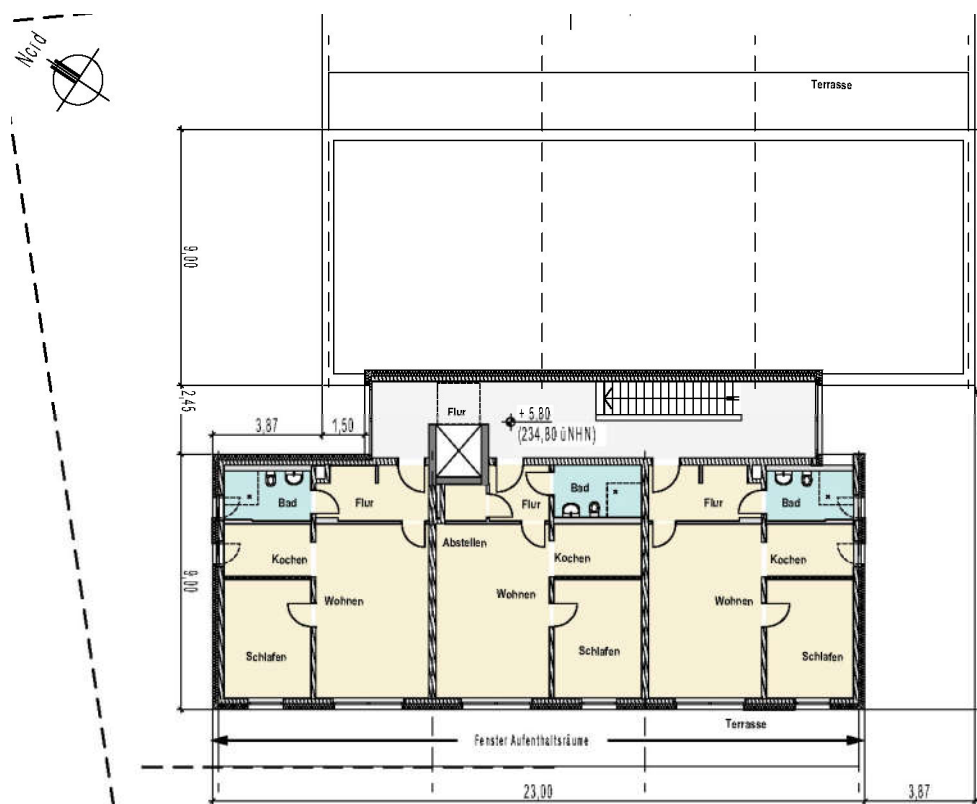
Grundriss 2. Obergeschoss / Betreutes Wohnen
